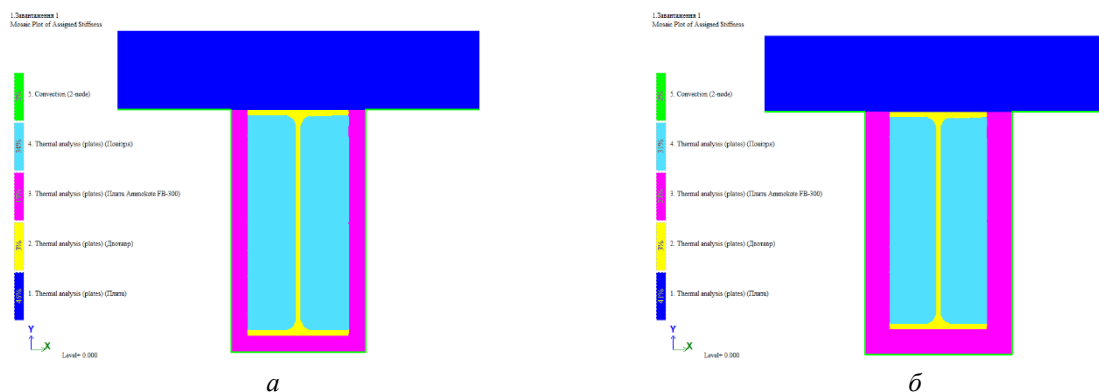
Розрахункова схема конструкції: а – 1-й варіант; б – 2-й варіант.
